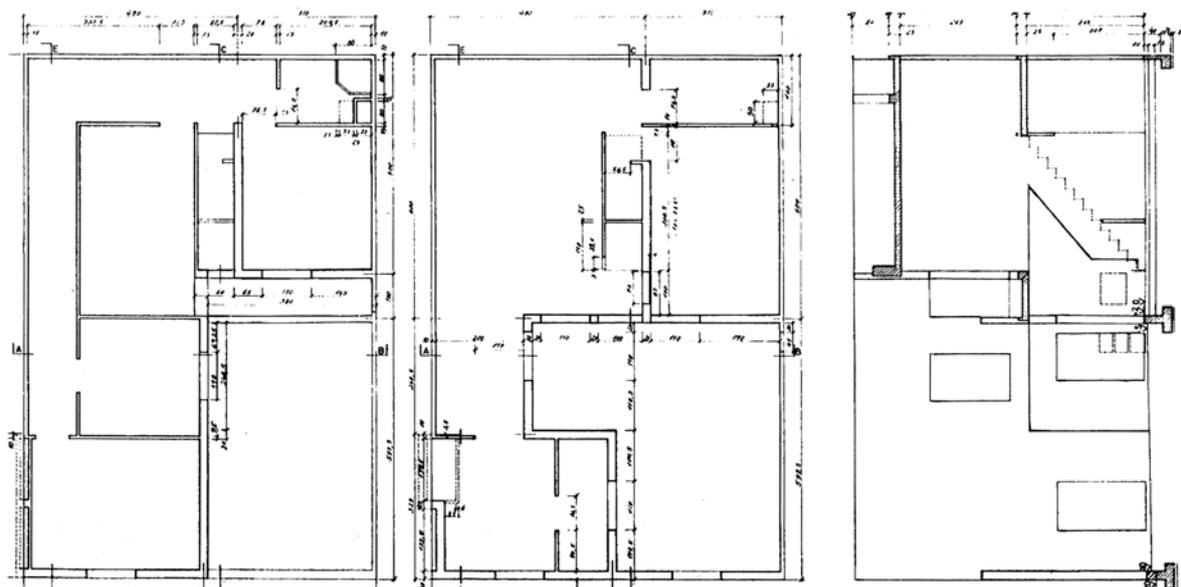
Viviendas de Tipología A. Planta de fundaciones y cubierta, planta baja y planta primera. Secciones y alzados.
